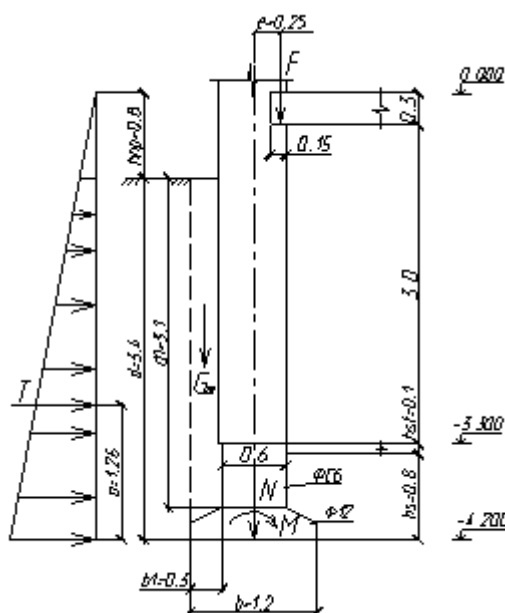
Схема фундаменту під зовнішню стіну
